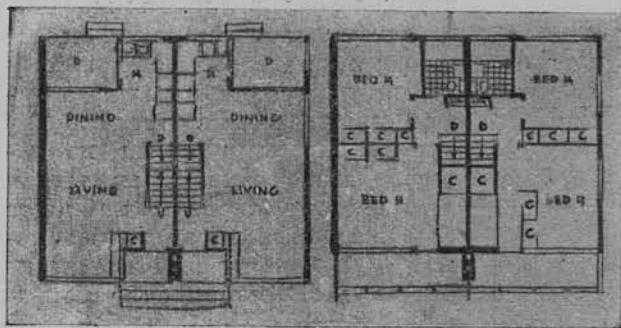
План типового жилого дома. Проект арх. Раймонда
